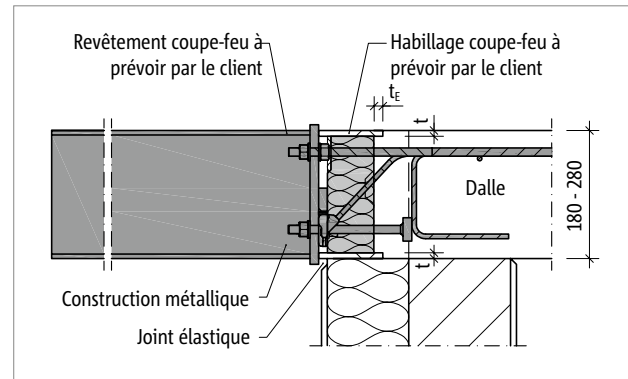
Schöck Isokorb® type SK : bardage de protection incendie sur site type SK, structure en acier avec revêtement de protection incendie ; coupe
